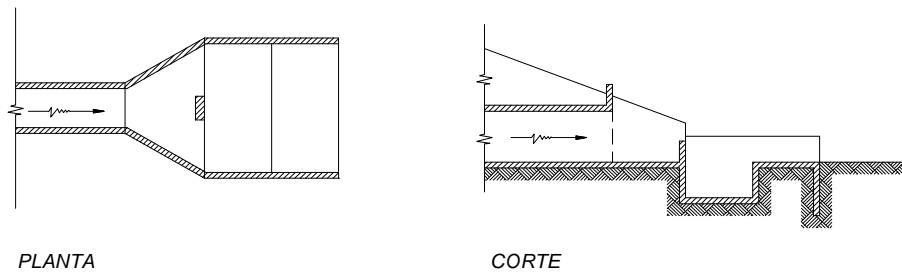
TERMINAL DE ALCANTARILLA CON BATEA DE GAVIONES
